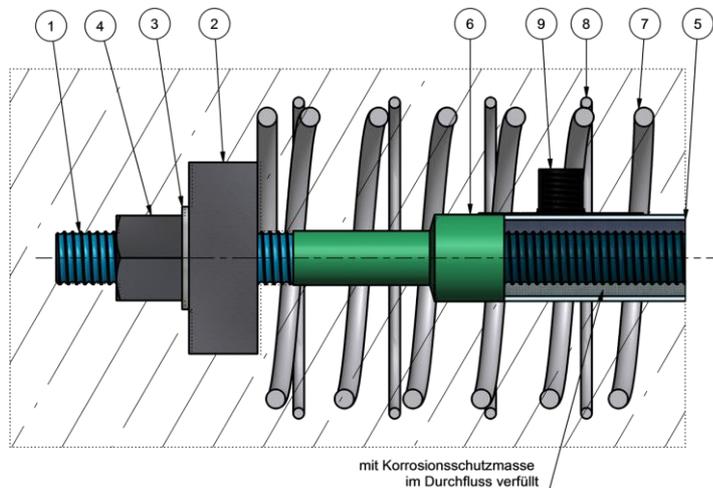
Einbetonierter Festanker, Bsp. Ø36
